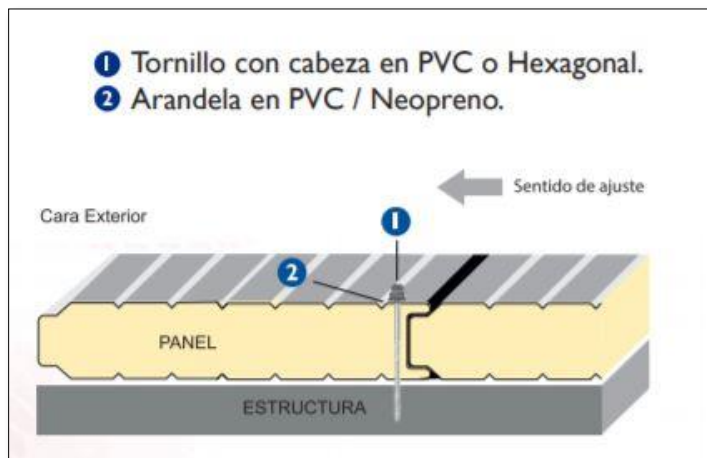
Sistema de anclaje entre paneles tipo sándwich
